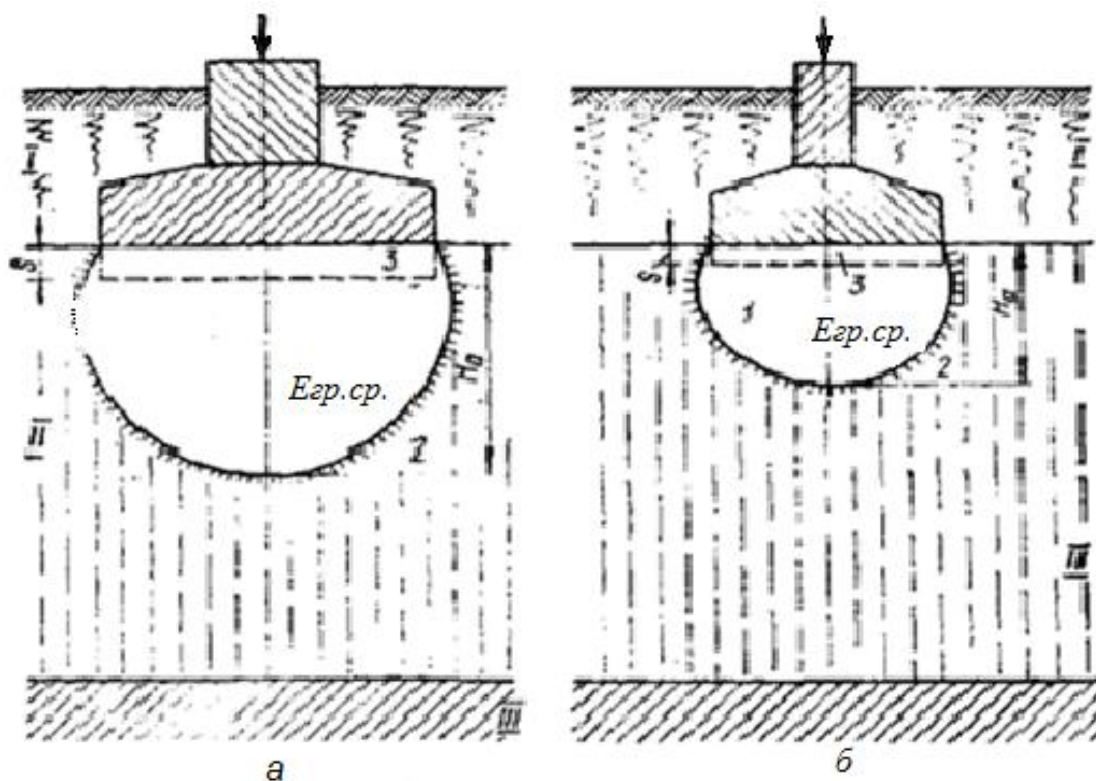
Схема роботи фундаменту на лесових ґрунтах
